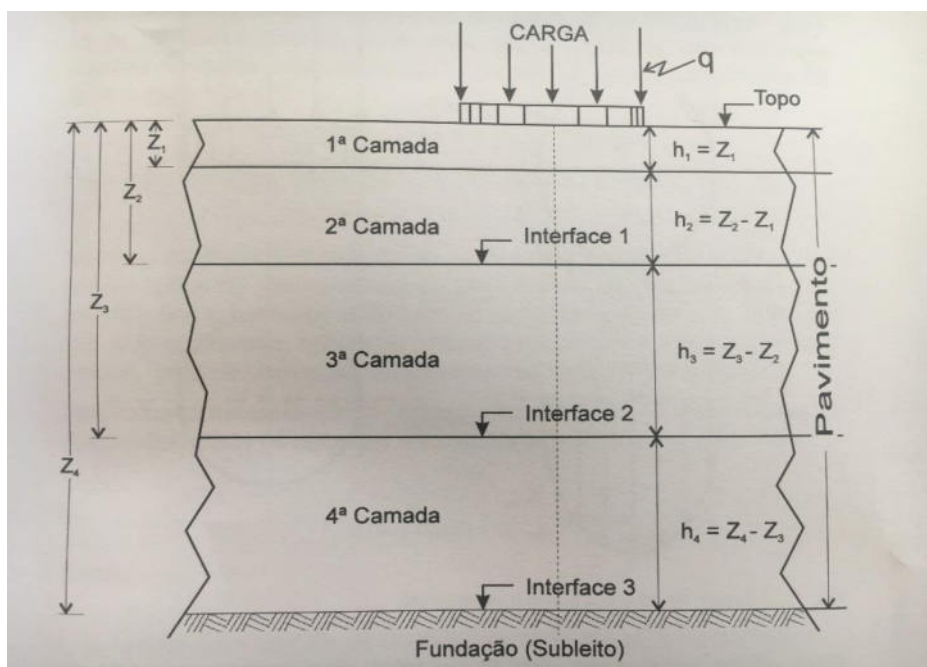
Esquemático da estrutura de camadas do pavimento – (Fonte: Senço, 2007)
